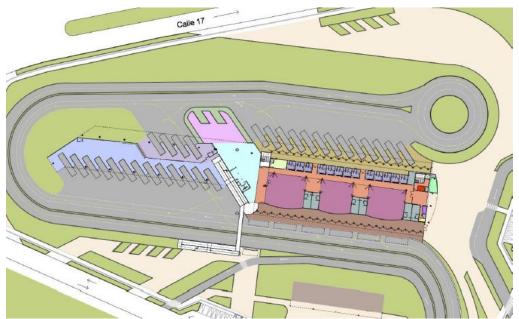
Diseño de Terminal de Transporte Terrestre, Barranquilla.
